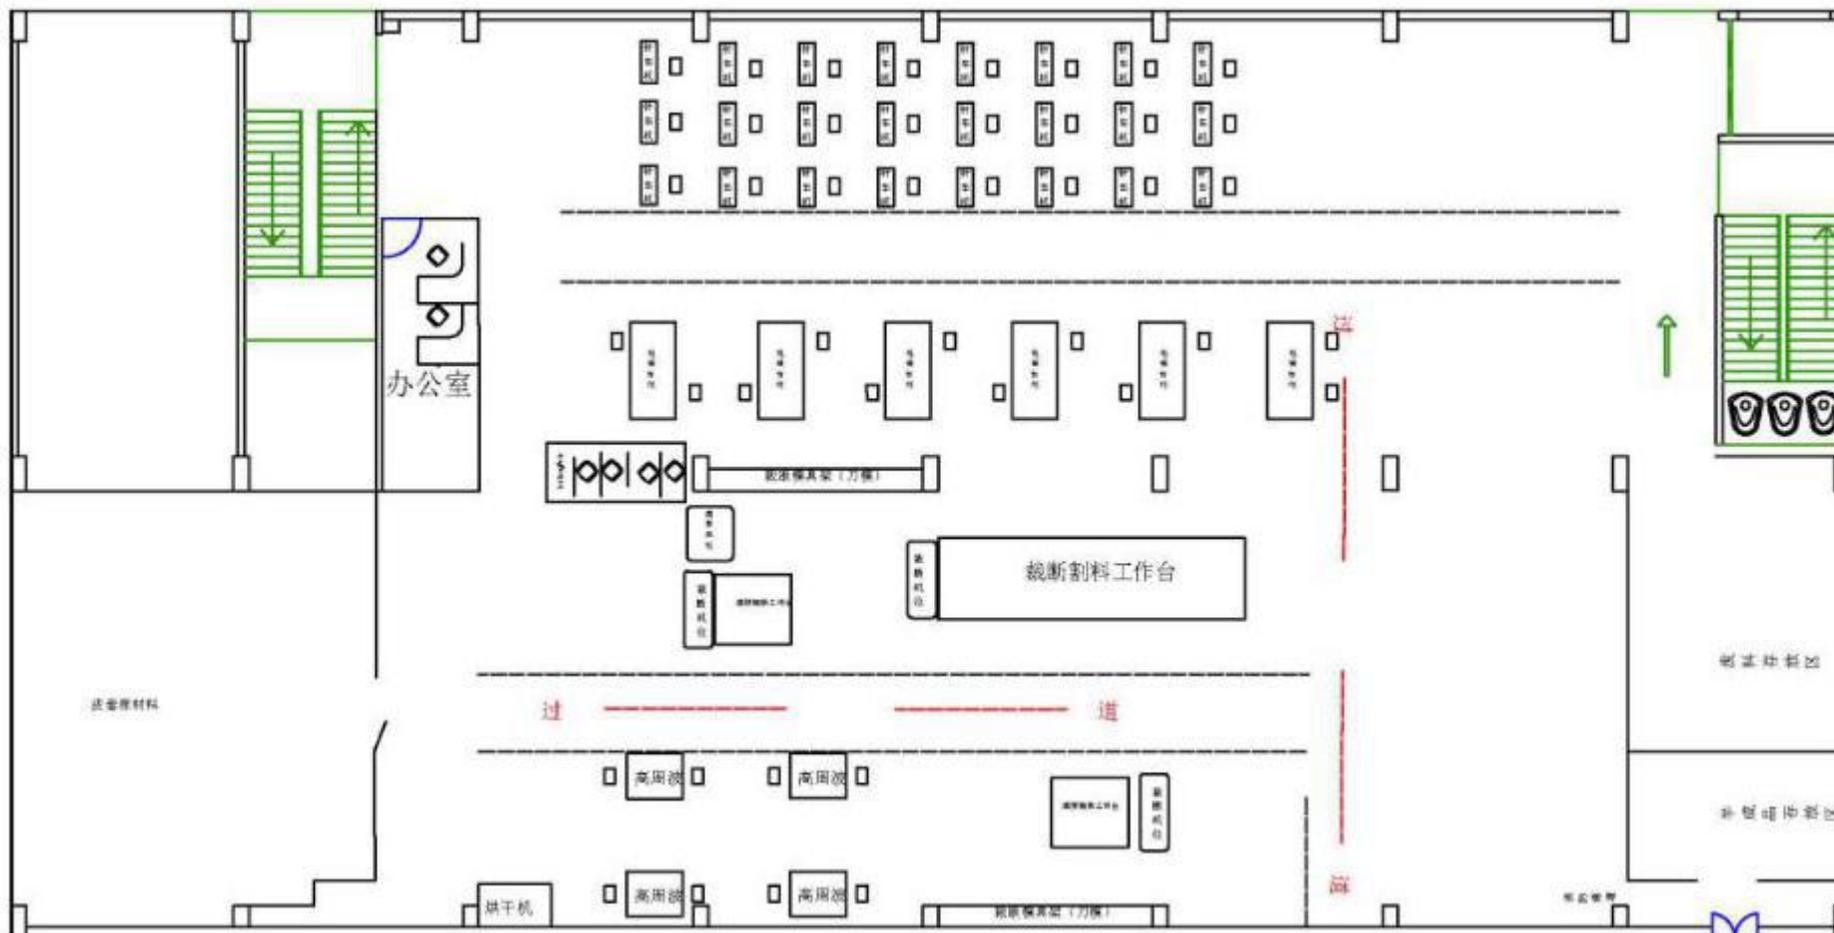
厂房平面布置图（皮套车间，E 栋三层，新增）
